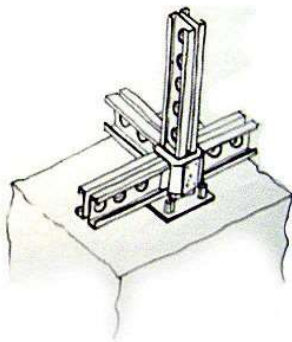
Estructura metálica para estabilizador de fachada interno sin muros medianeros o transversales a conservar.
